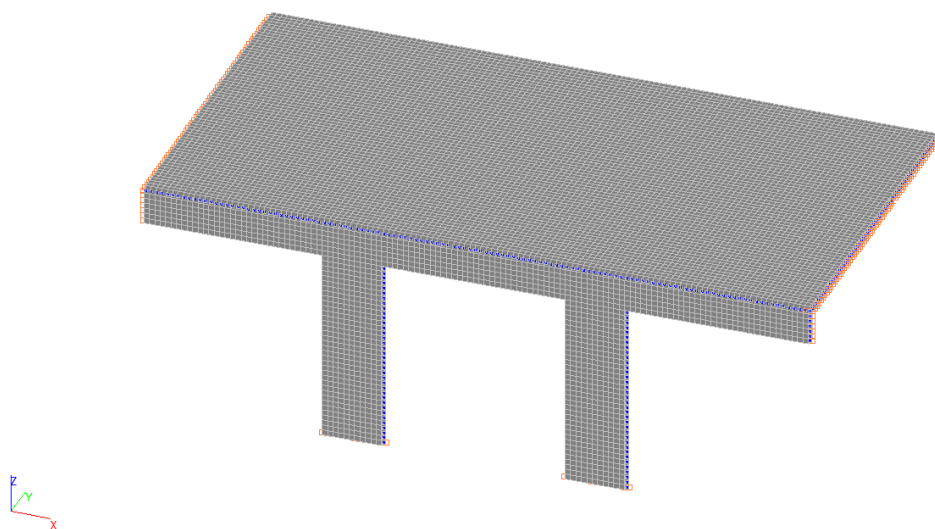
Расчётная схема участка монолитной стены в пространстве
